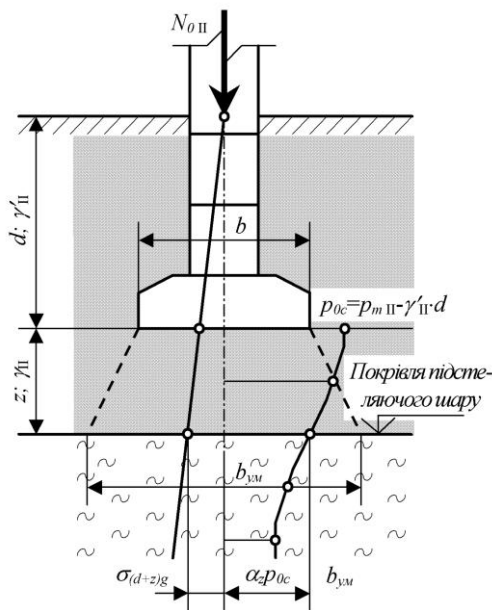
Розрахункова схема до перевірки міцності слабого ґрунту підстеляючого шару основи
